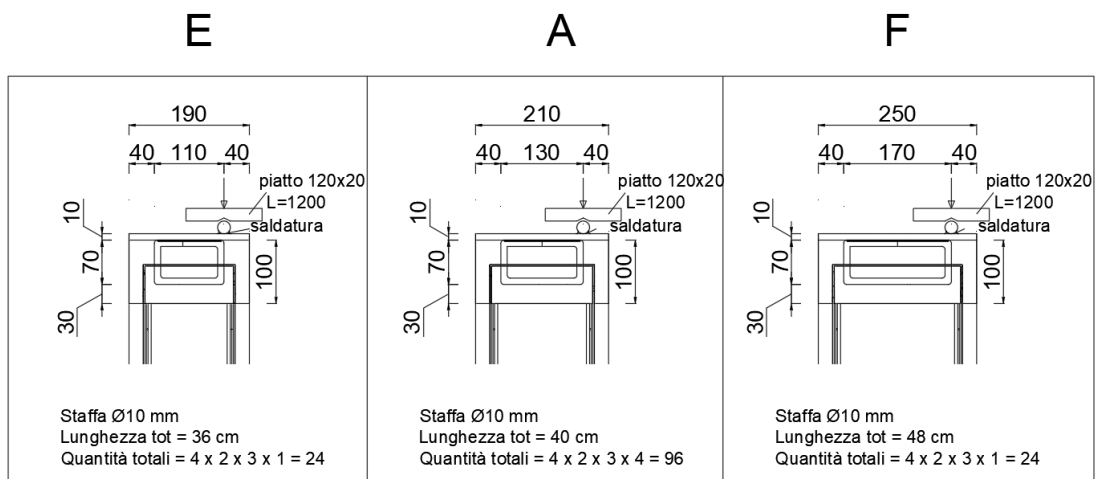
Planimetria e sezione della disposizione delle reti metalliche e connettori
